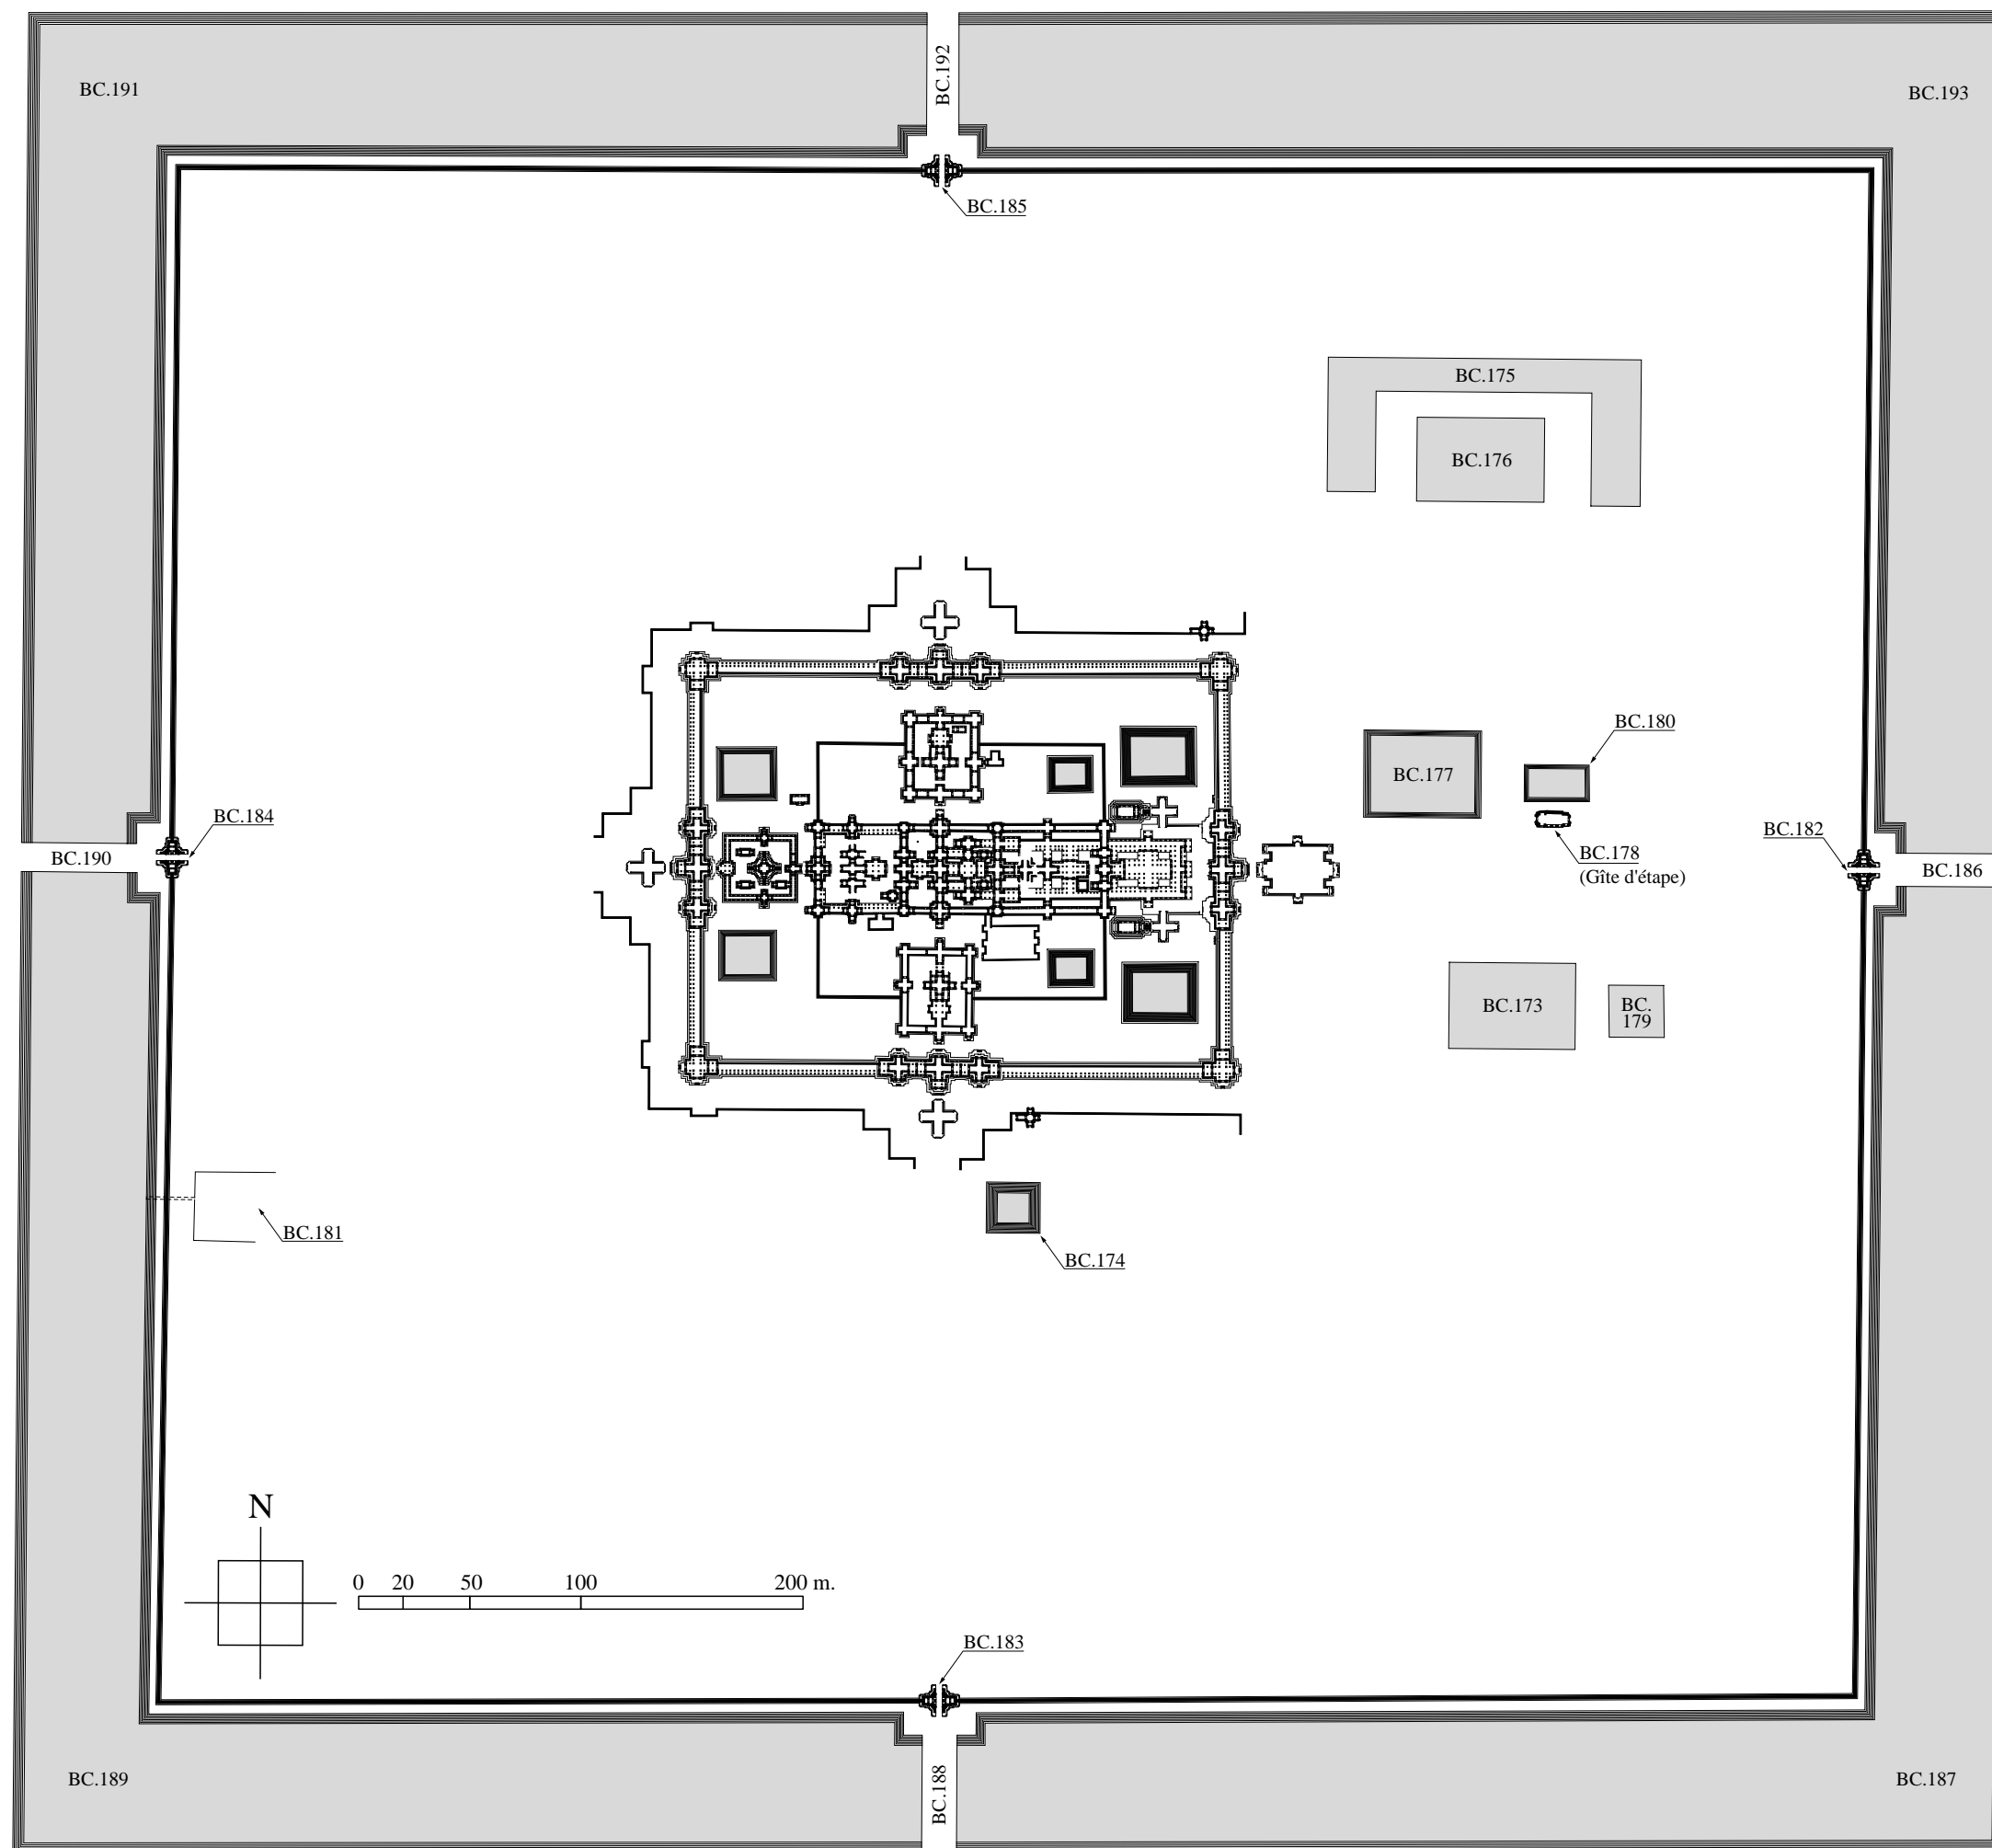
Plan du domaine de Banteay Chmar
